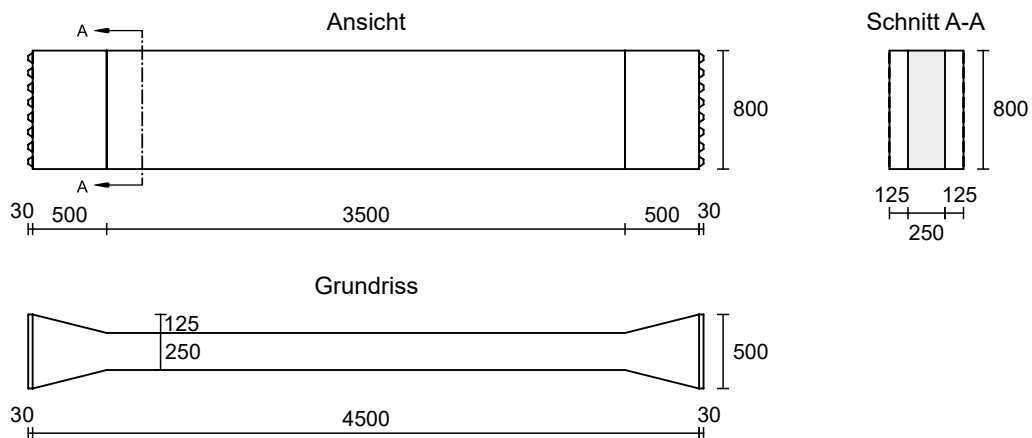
Abmessungen der Versuchsträger, Rechteckquerschnitt [mm]
